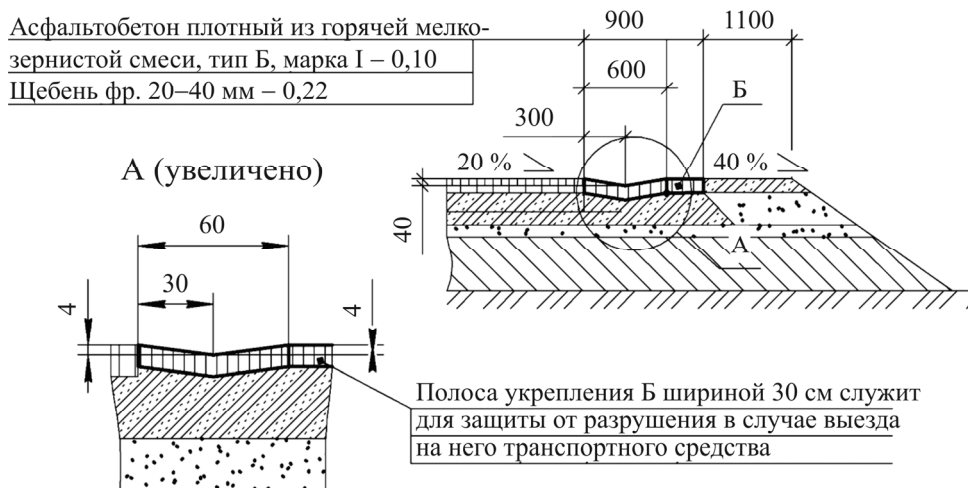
Пример конструкции лотка из асфальтобетона – поперечный профиль конструкции дорожной одежды с прикромочным лотком из асфальтобетона
